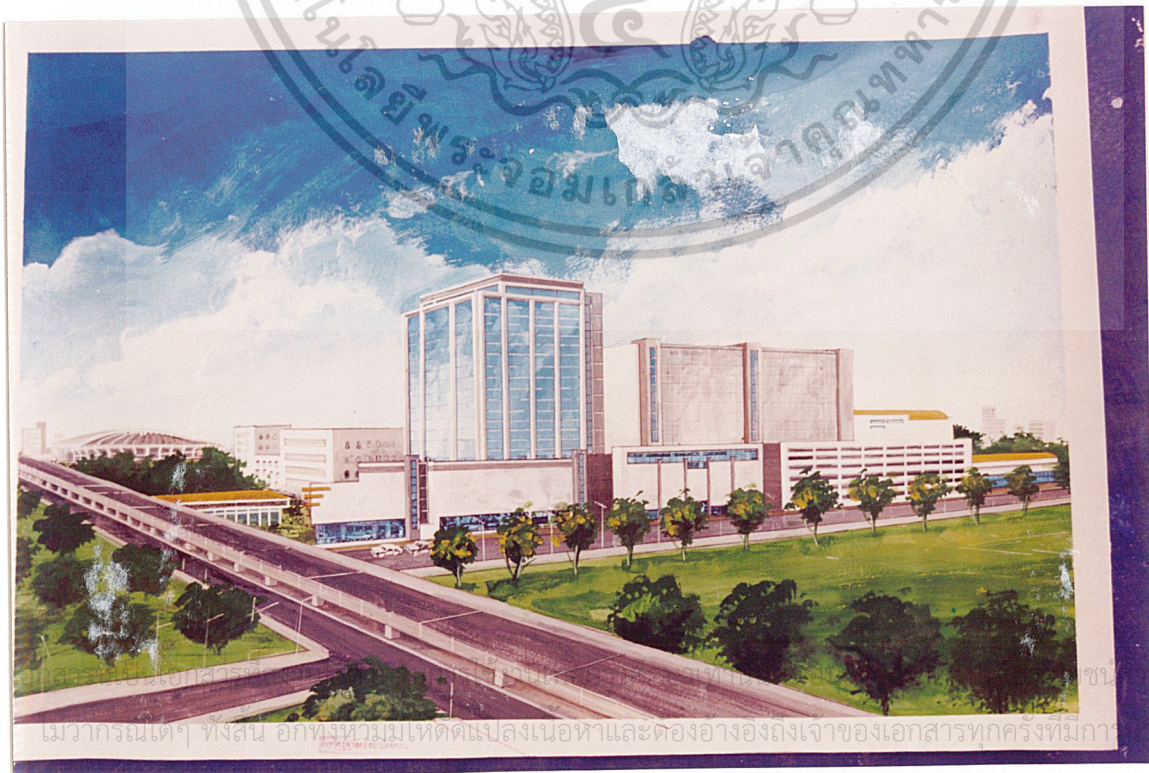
แสดงรูปด้านของโครงการ
